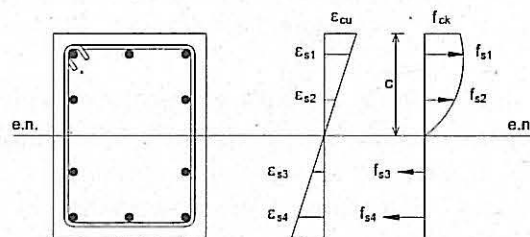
Base para a determinação da cedência em barra de betão armado.
